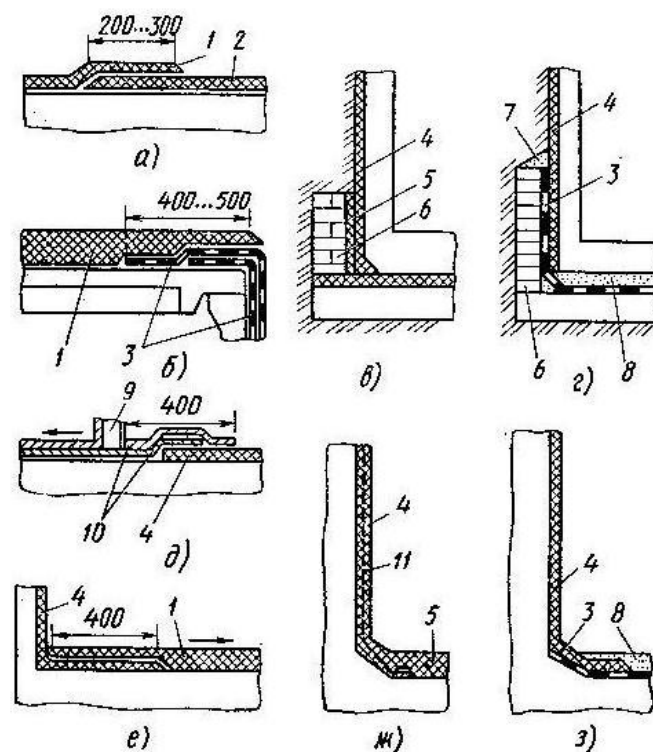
Сопряжения гидроизоляции (а—з) на горизонтальных поверхностях и на пересечениях горизонтальных поверхностей с вертикальными:
